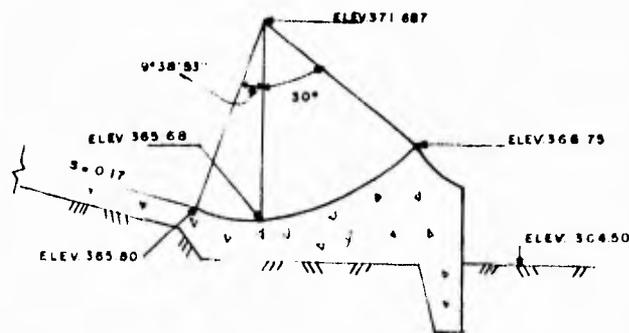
DETALLE DE ESTRUCTURA TERMINAL.
